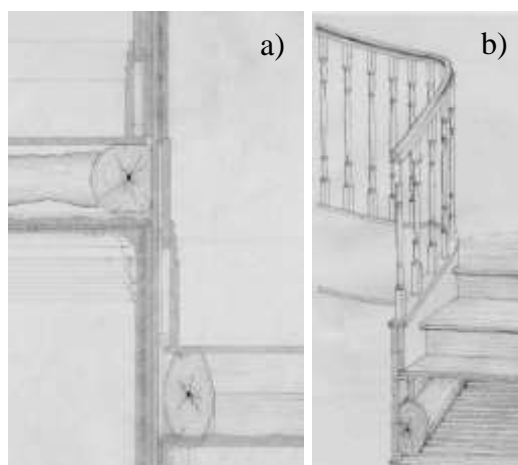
a) Pormenorização tipo de uma parede de tabique da caixa de escadas; b) Pormenor de lanço de escadas interiores (Teixeira, 2004).
